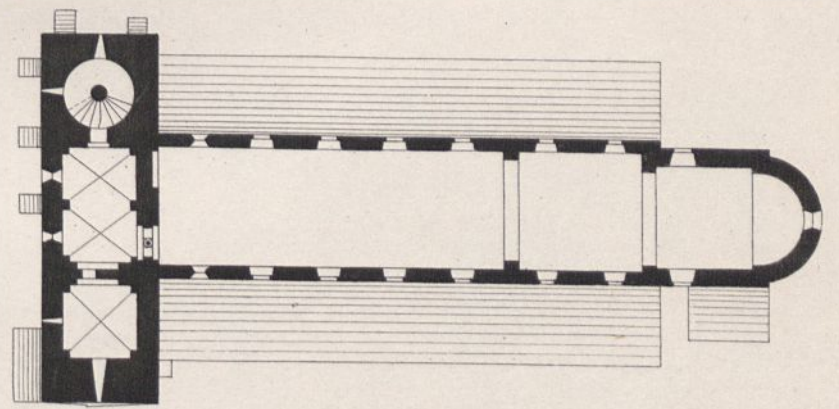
Oberer Grundriss der jetzigen Kirche.
